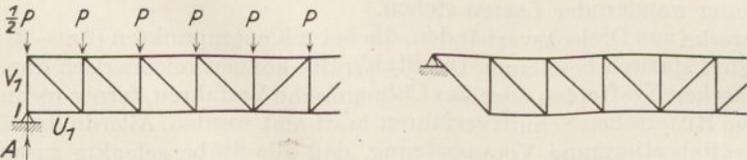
u. b. Parallelträger mit fallenden Schrägstäben.
